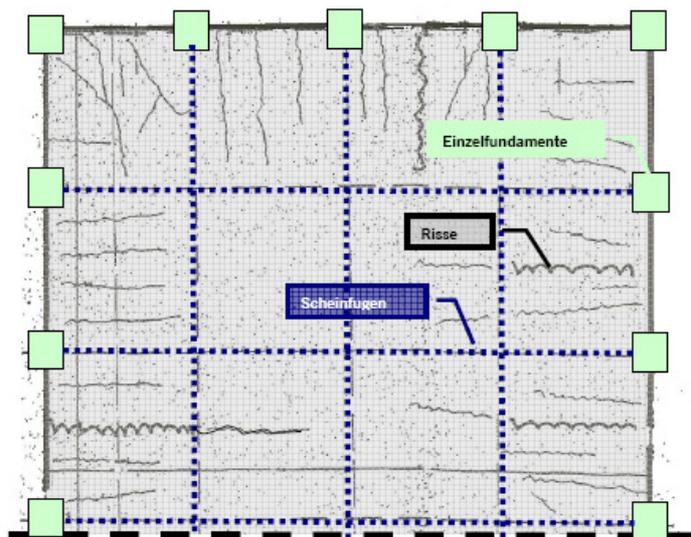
Mögliches Rissbild bei Einspannung in Einzelfundamente
